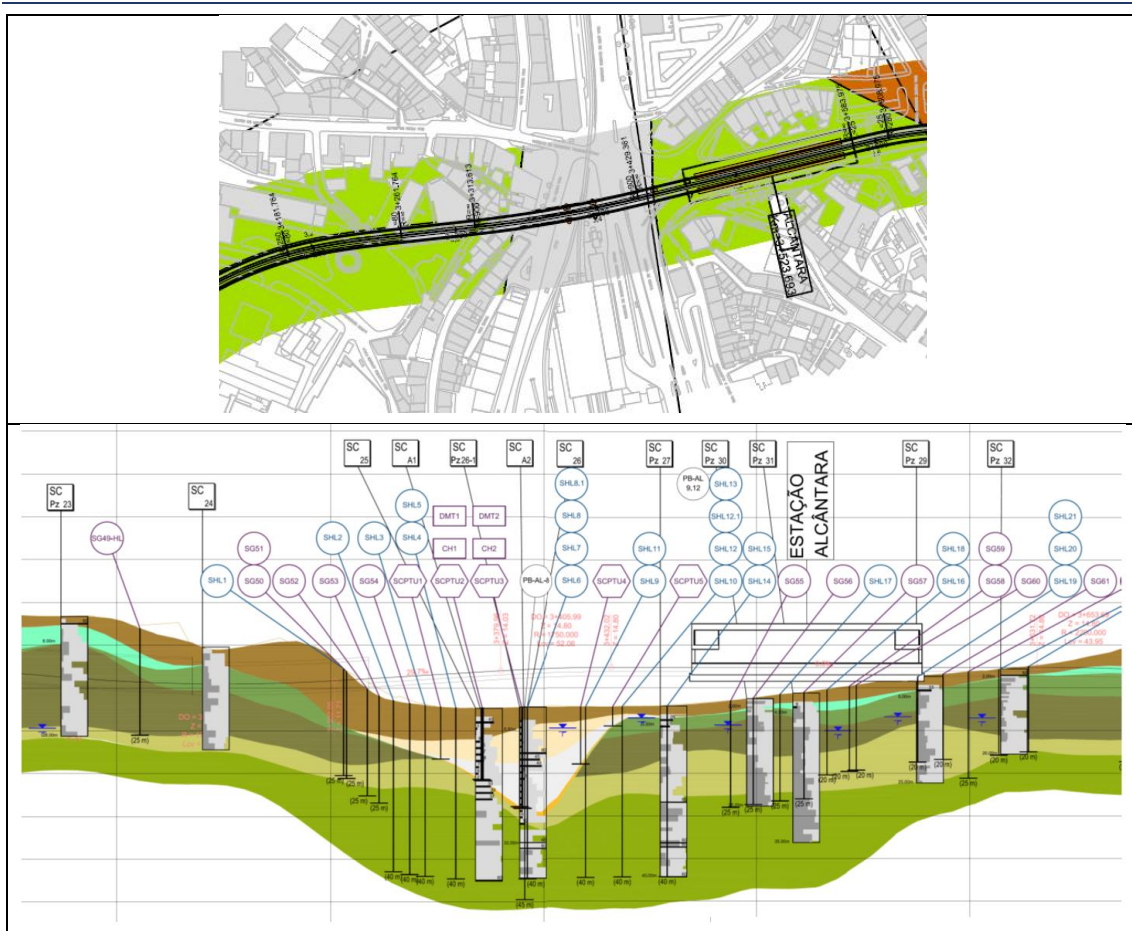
Planta e perfil longitudinal – Geologia / Geotecnia
